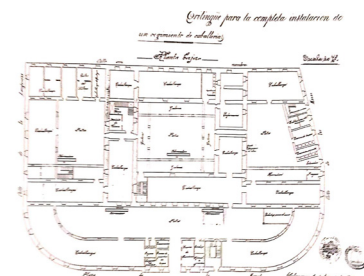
Planta baja Cuartel del Trilingüe. Pedro Vidal, 1900
